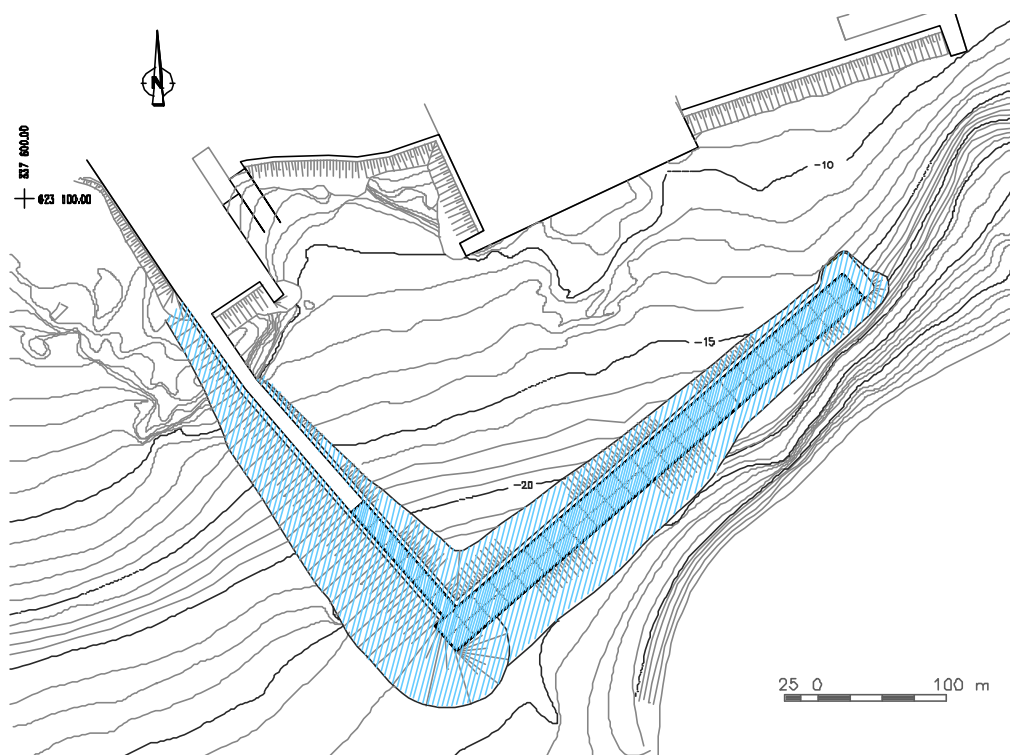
Molhe exterior. Solução inicial. Configuração em planta
